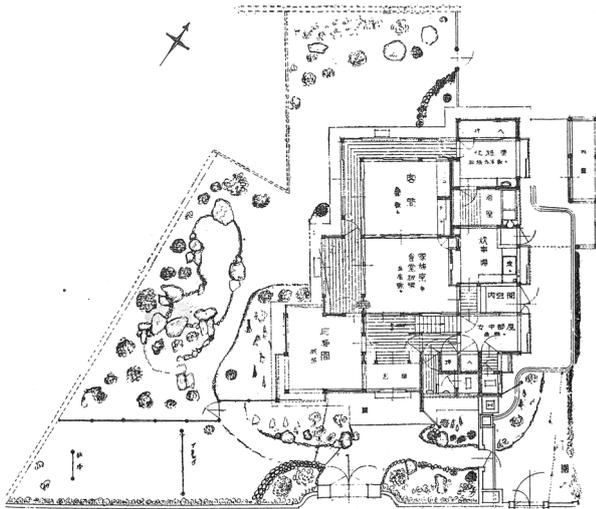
尾辻国吉郎(福州街11号日式宿舍)平面図
